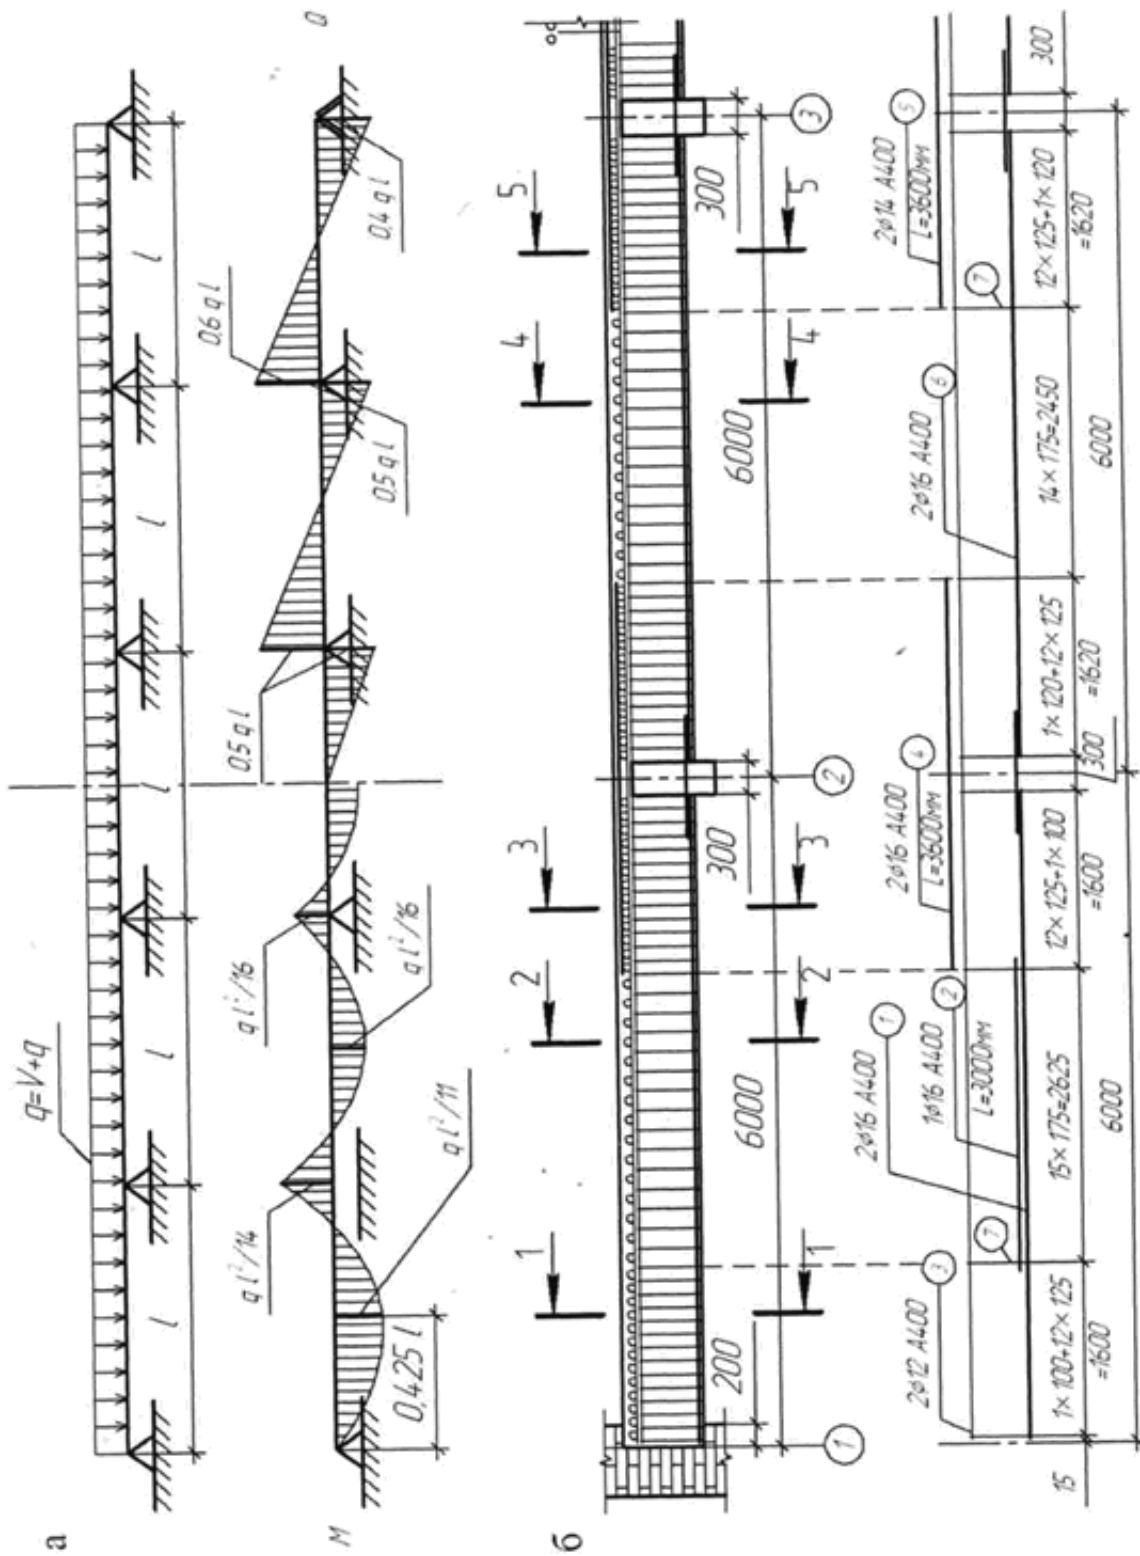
Второстепенная балка: а – расчетная схема плиты и эпюры усилий M и Q ; б – армирование балки
